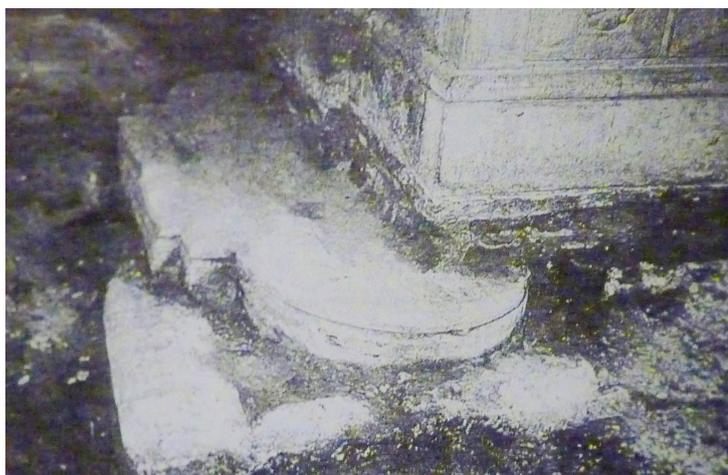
La base della colonna emersa durante i lavori di ripavimentazione del portico.
